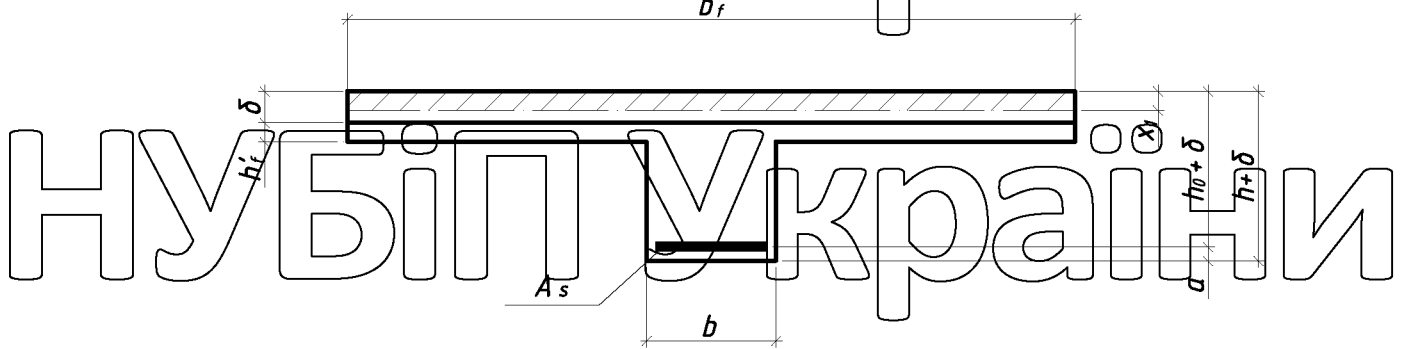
Розрахунковий переріз плити з підсиленням.
